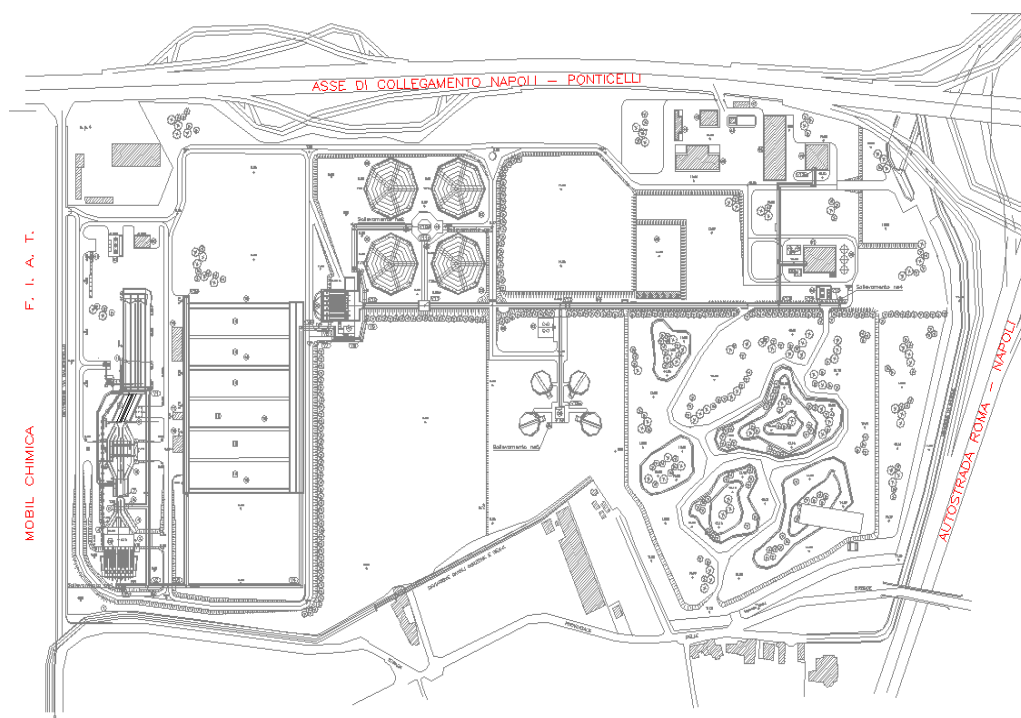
Planimetria Generale dell'Impianto di depurazione Napoli EST e rete dei collettori.
